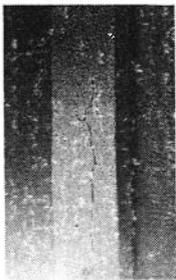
Fissura na viga da sala da coordenação.
